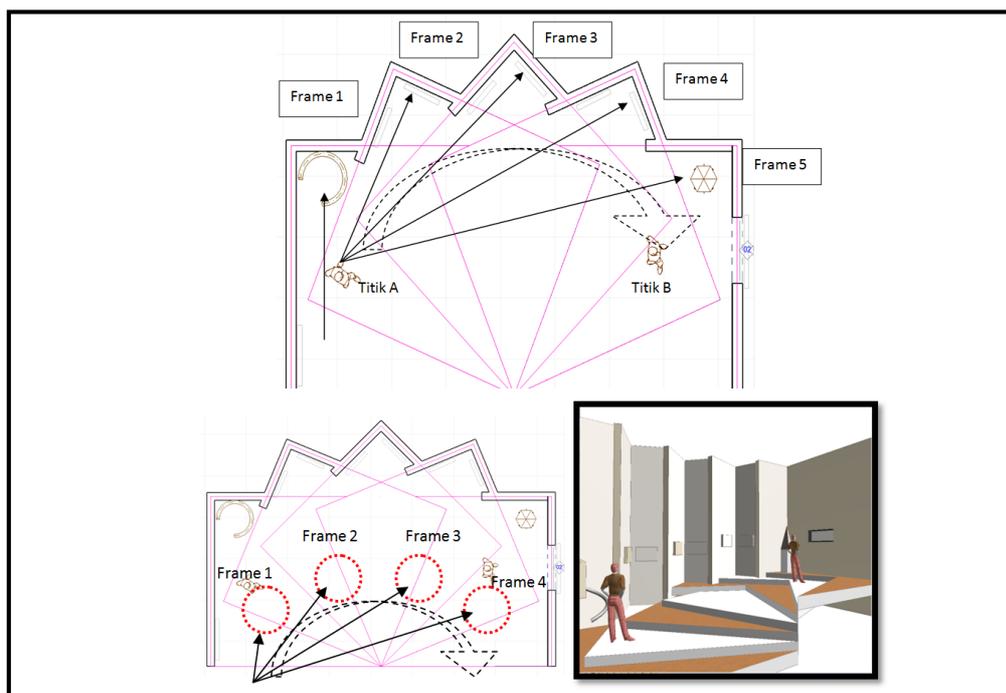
Penerapan Konsep Pada level lantai dan plafon Kelas.
